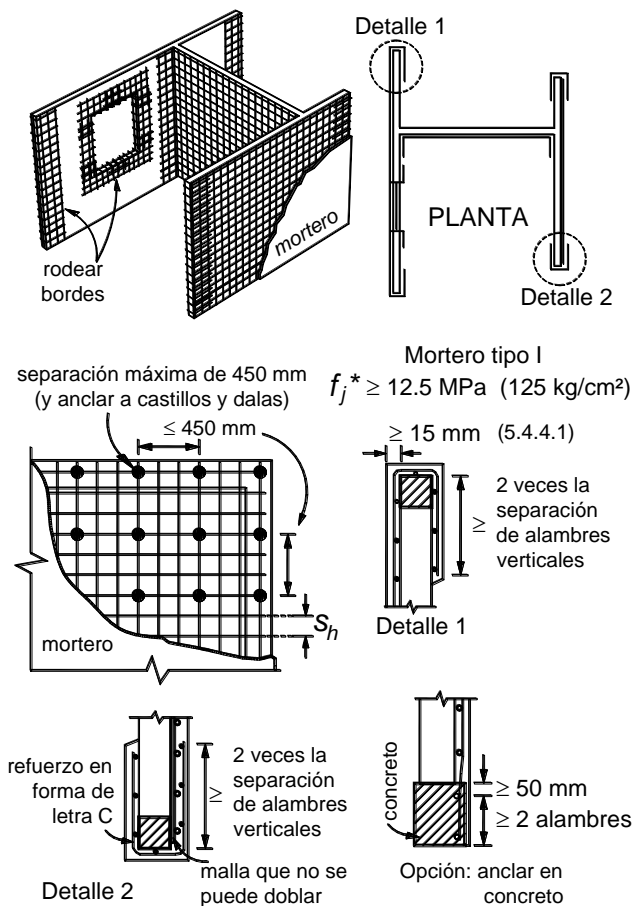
Refuerzo con malla de alambre soldado y recubrimiento de mortero
